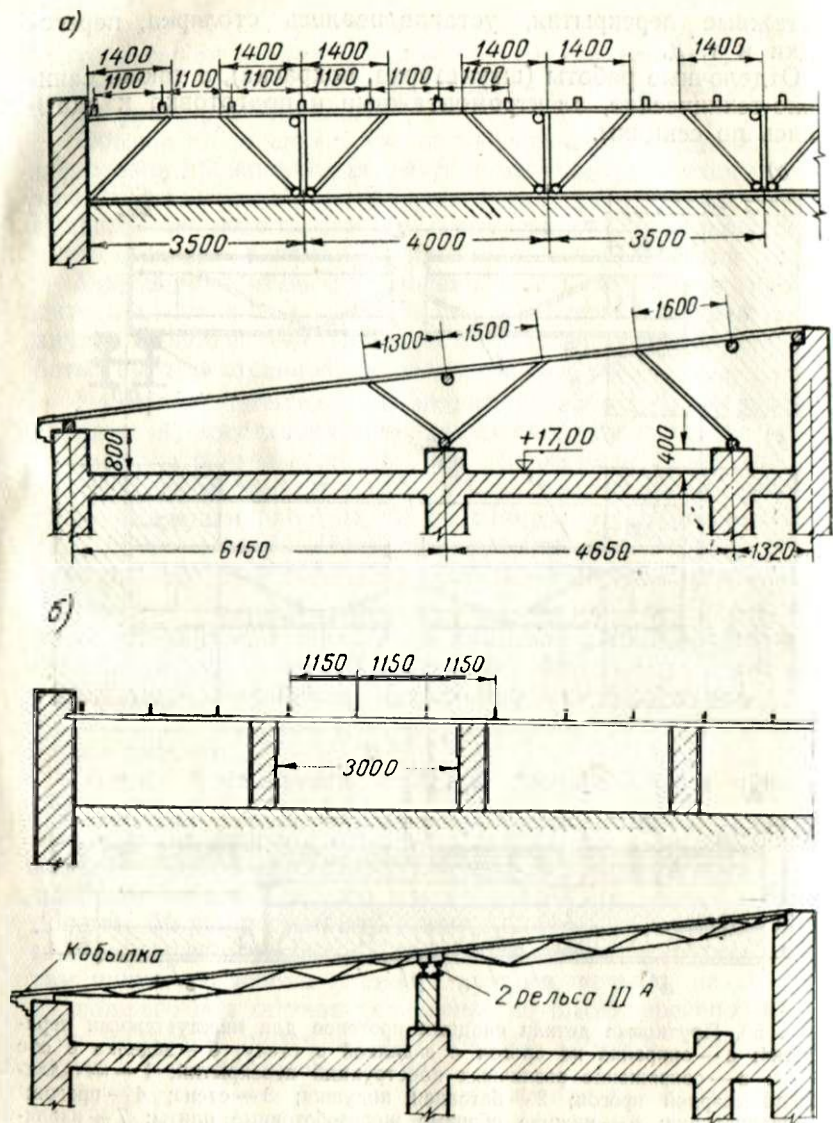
Схемы устройства кровельного перекрытия на доме № 8-а: а — деревянное перекрытие по проекту; б — осуществленное в натуре с металлическим прогоном.
